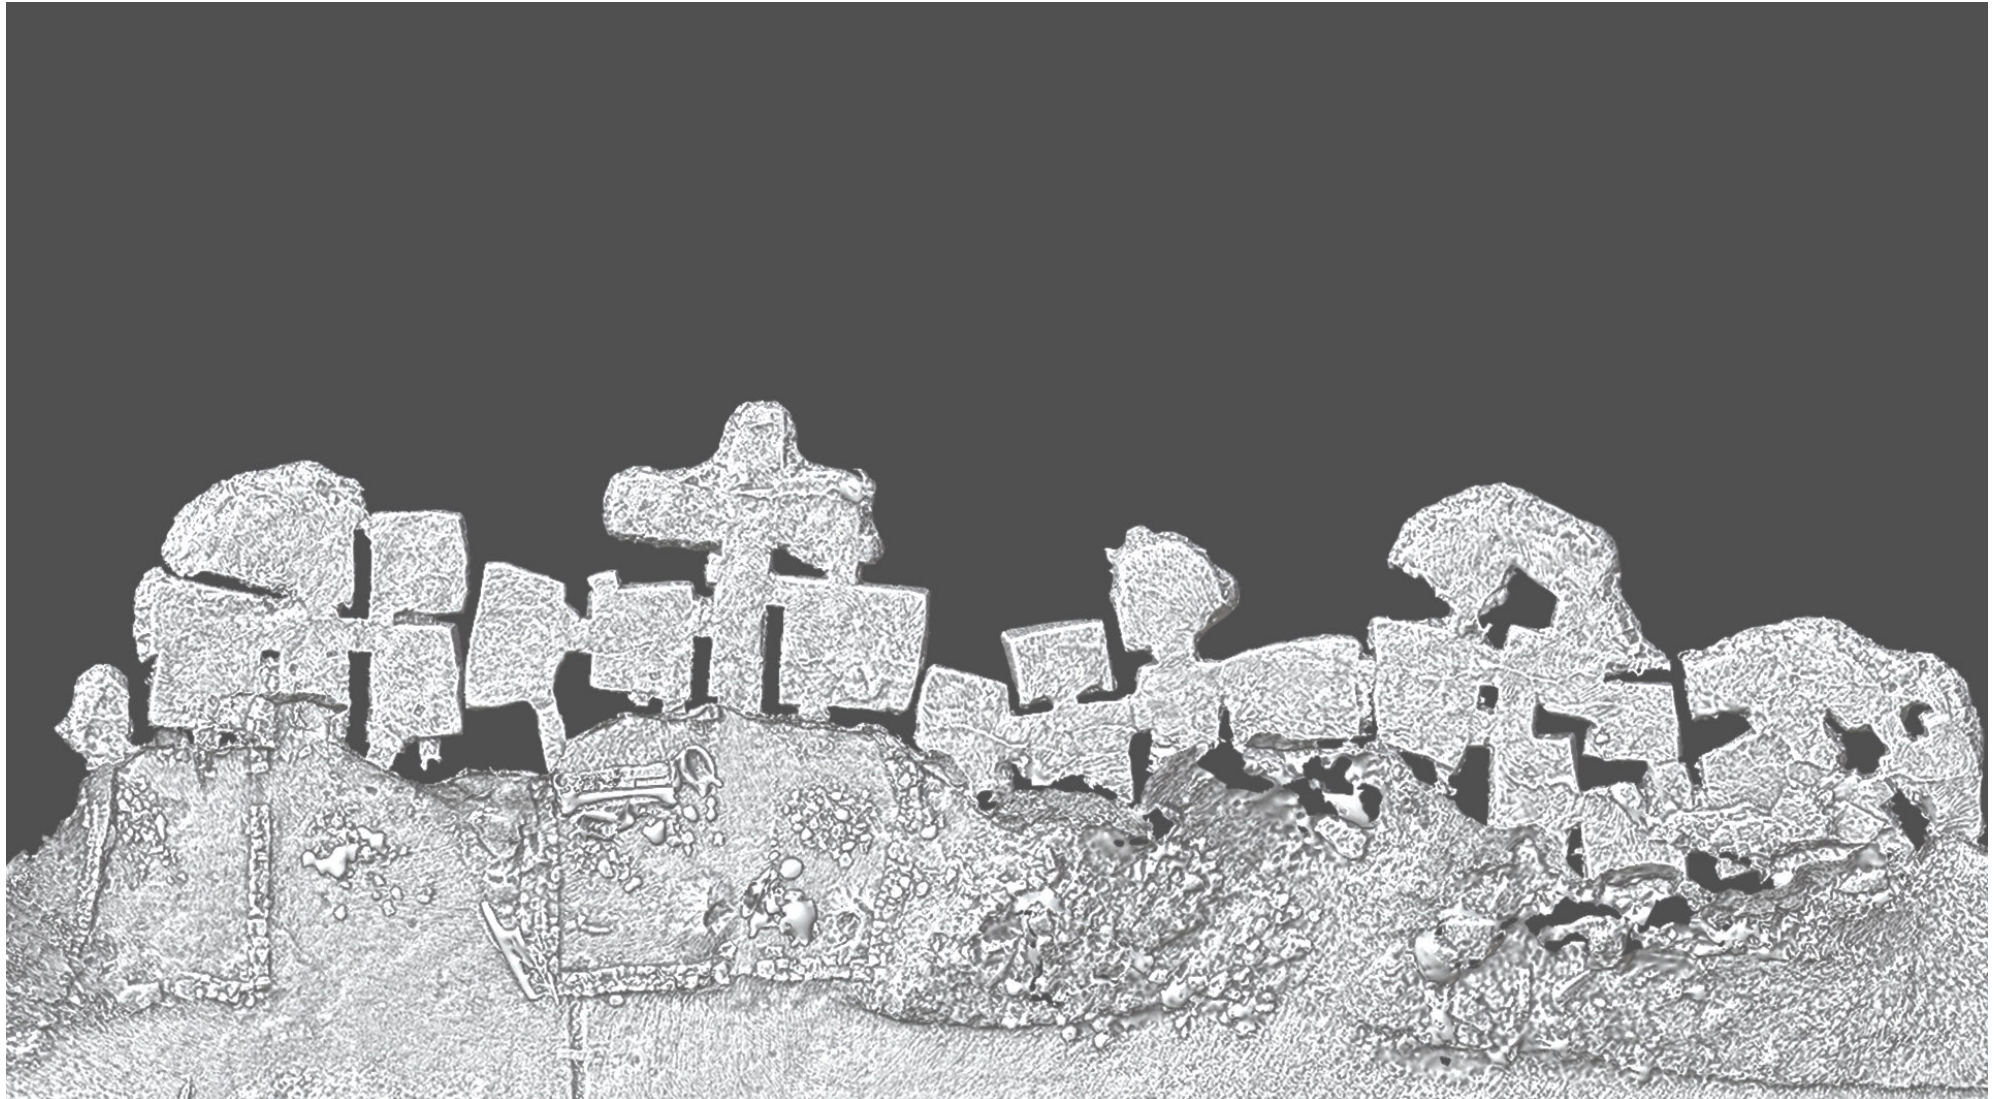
Distribución interior en planta de las cuevas de la ladera oeste. Fuente: *Elaboración propia
